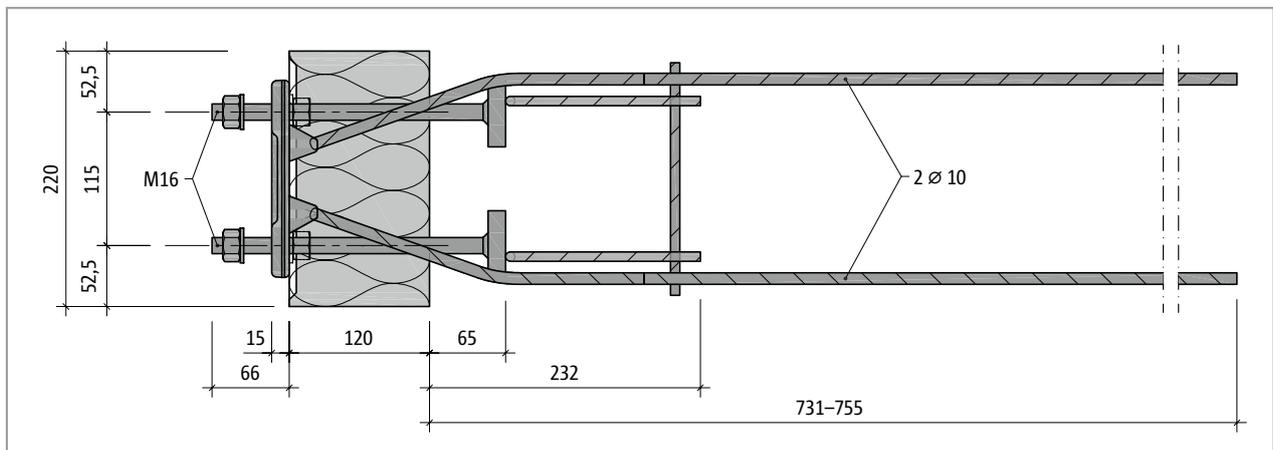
Schöck Isokorb® XT tipo SQ-V2: Plano
